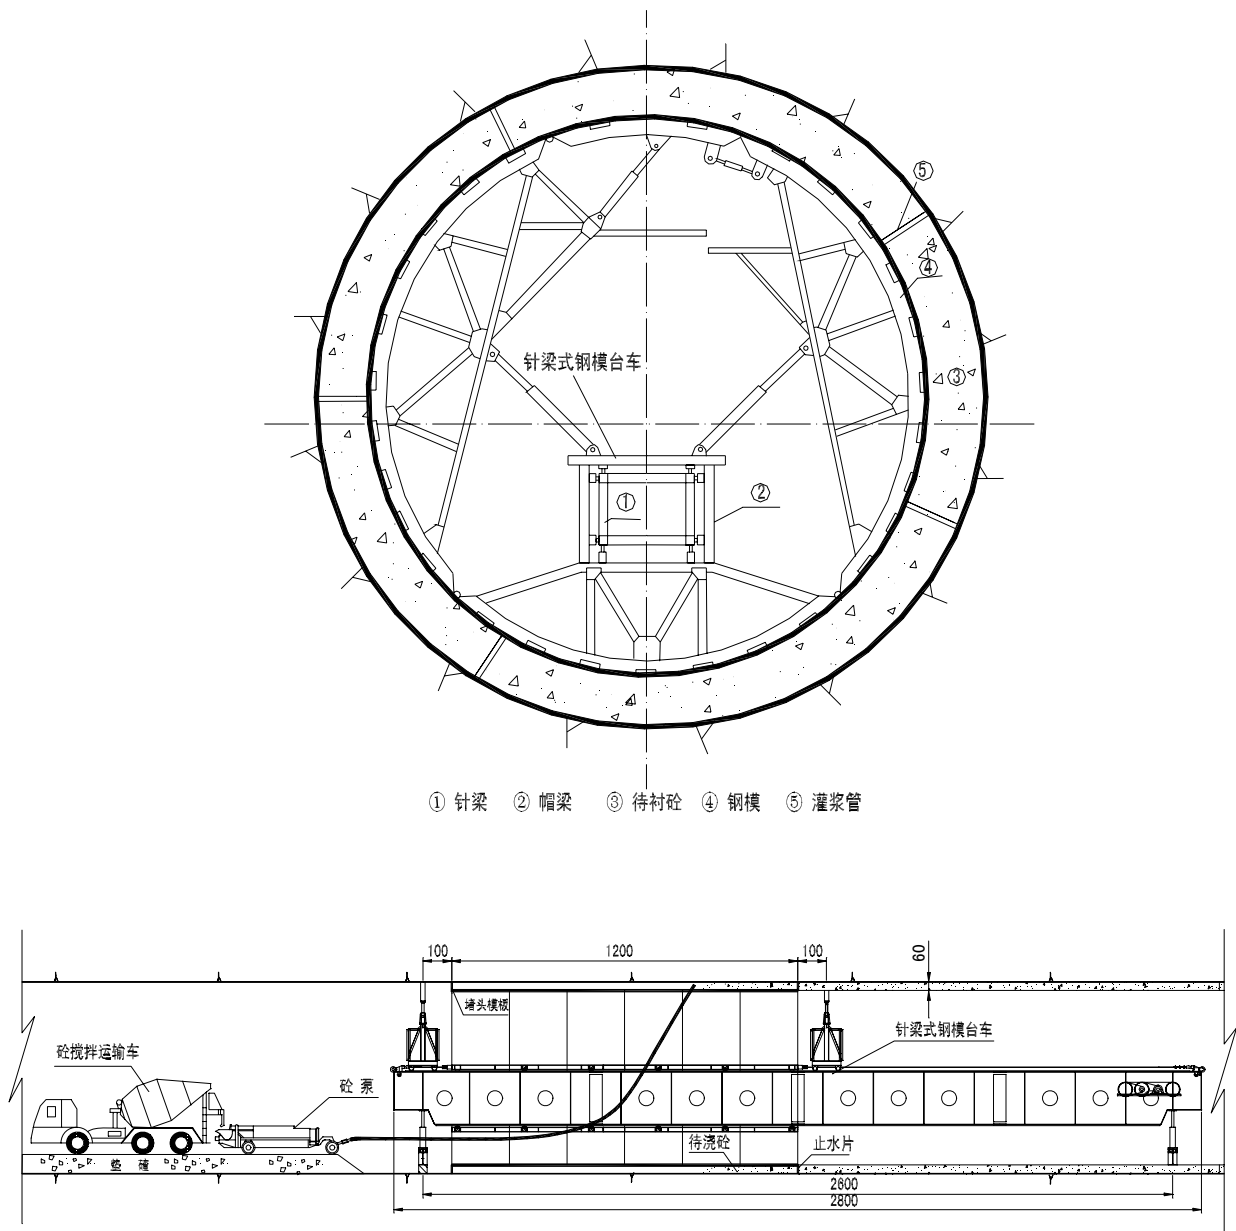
针梁式钢模台车衬砌混凝土施工方法图
